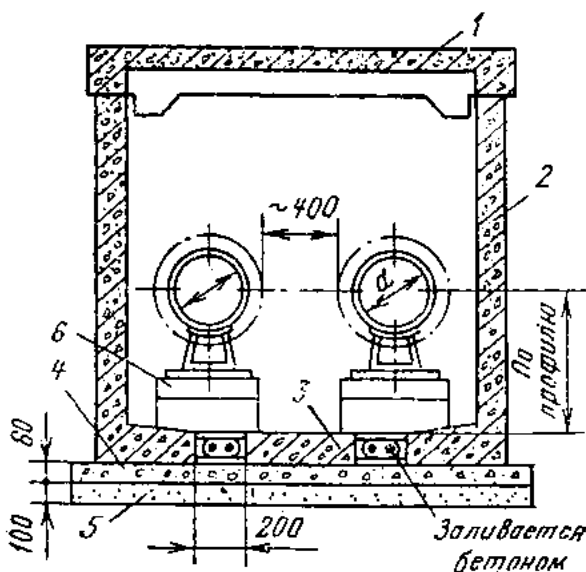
Сборный полупроходной канал из железобетонных блоков: 1 – ребристый блок перекрытия; 2 – стеновой блок; 3 – блок днища; 4 – бетонная подготовка; 5 – щебеночная подготовка; 6 – опорная плита
